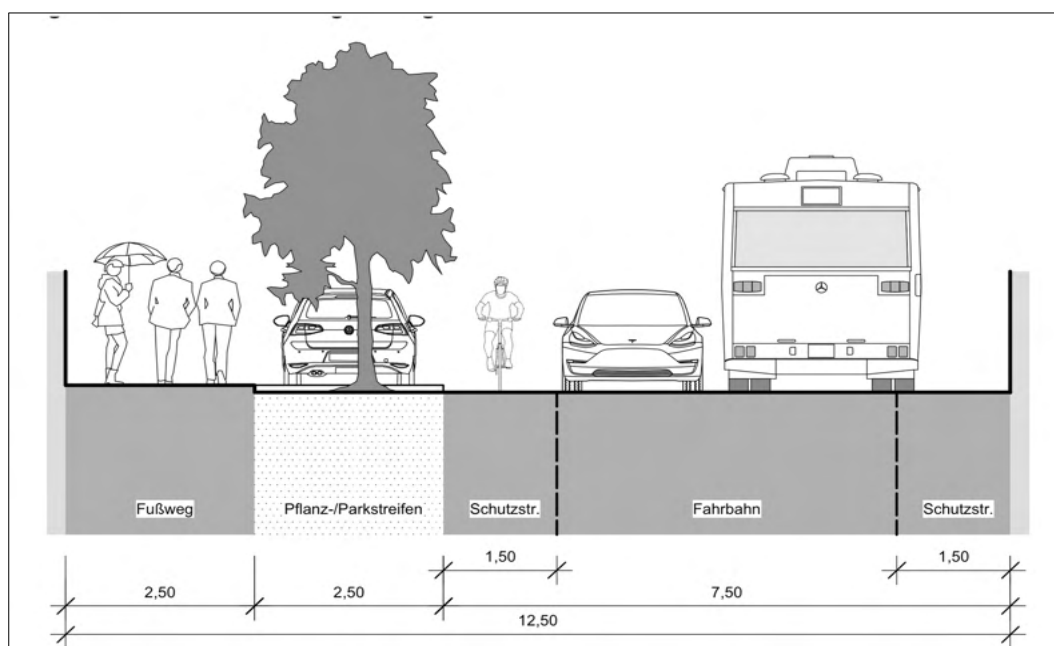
Straßenquerschnitt für Planstraße A / Vorschlag
